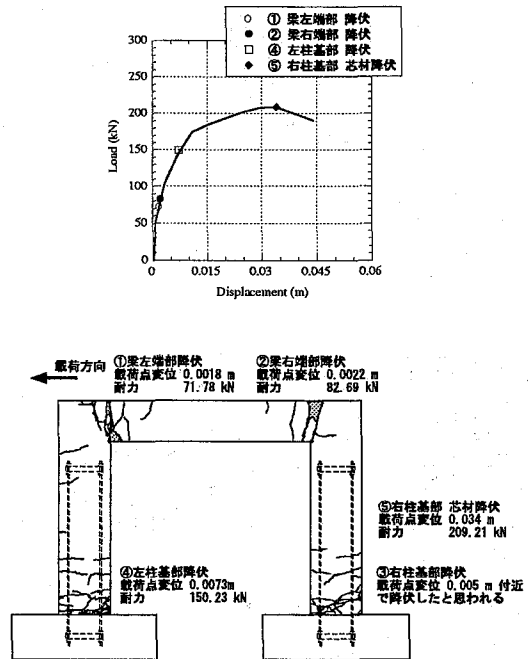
UBRC-1 供試体の降伏過程とひび割れ分布
